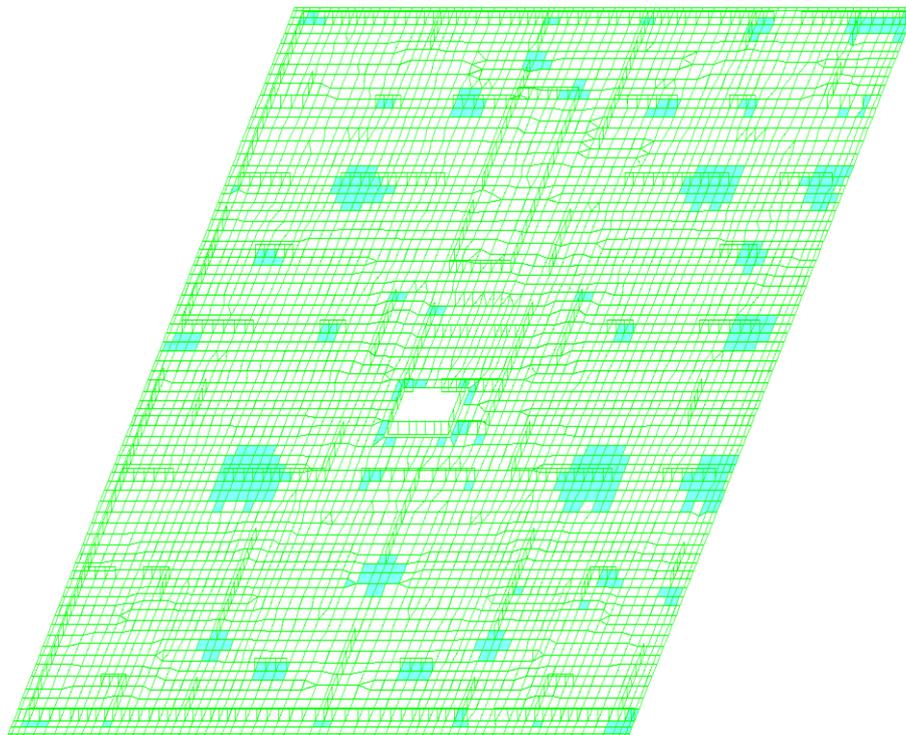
Площадь поперечной арматуры вдоль оси Y.
